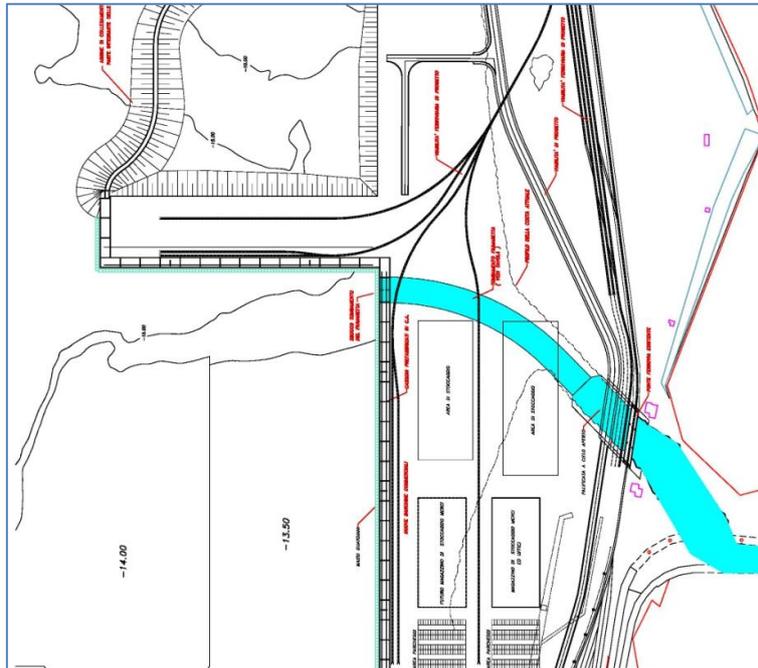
Stralcio planimetrico intervento di tombamento del Fosso della Fiumaretta nel tratto terminale in ambito portuale (tratto ciano).
